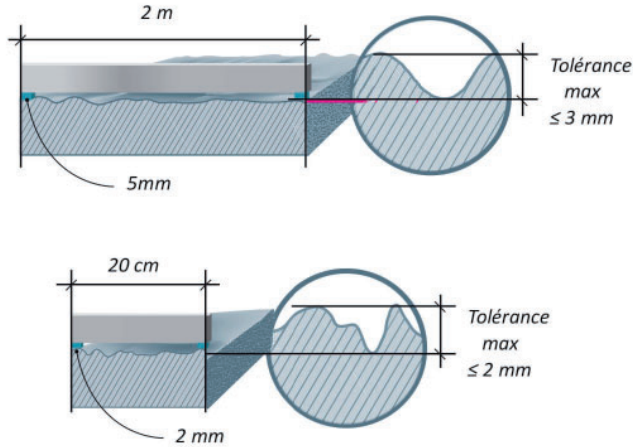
Tolérances de planéité du support pour une pose flottante de la chape ou de la dalle sur sous-couche isolante d'épaisseur $e \geq 5$ mm
